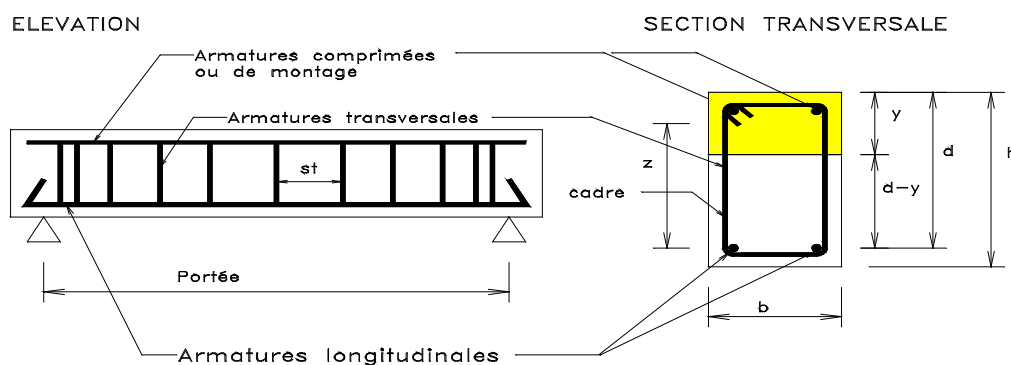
principe de ferrailage Dans un poutre en Béton armé
